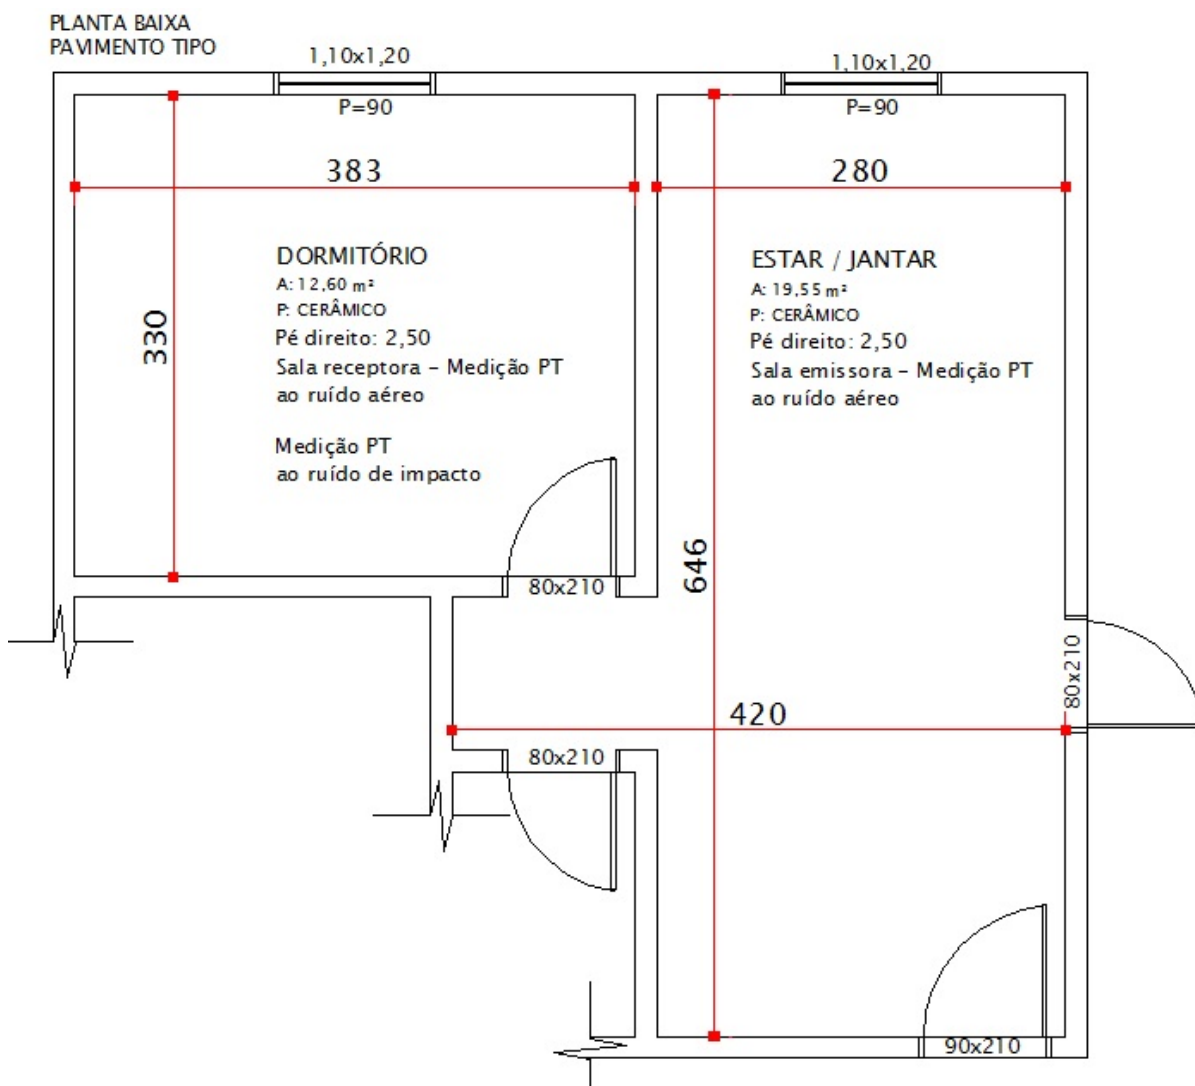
Planta baixa - pavimento tipo - 01-PIS-TV-PC
